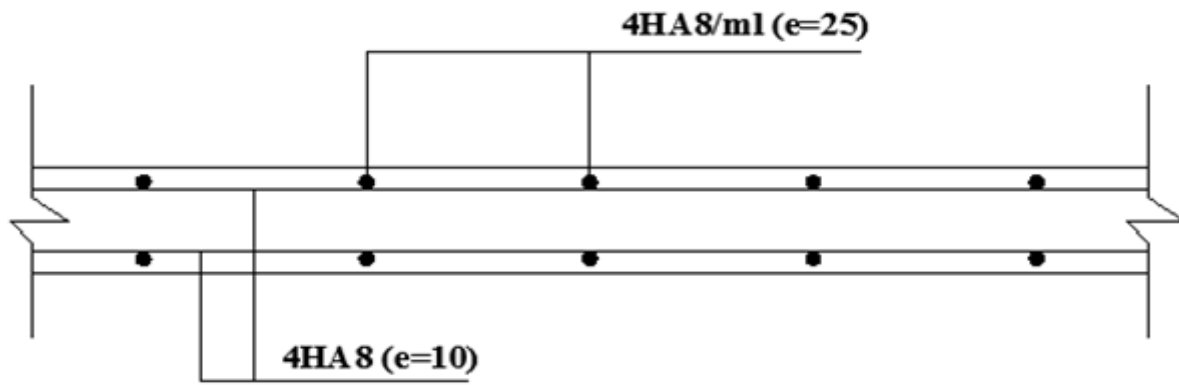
Coupe A-A Ferrailage de l'acrotère
